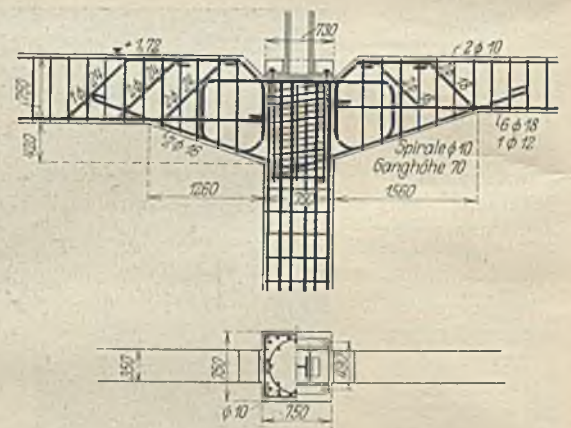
Auflagerung der Stahlstützen auf den Eisenbetontrageteilen der Kellergeschosse.
